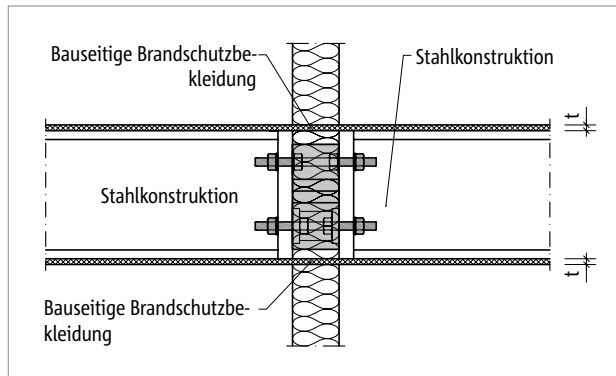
Brandschutz Schöck Isokorb® T Typ S: Bauseitige Brandschutzbekleidung bei bündigen Stirnplatten; Schnitt
